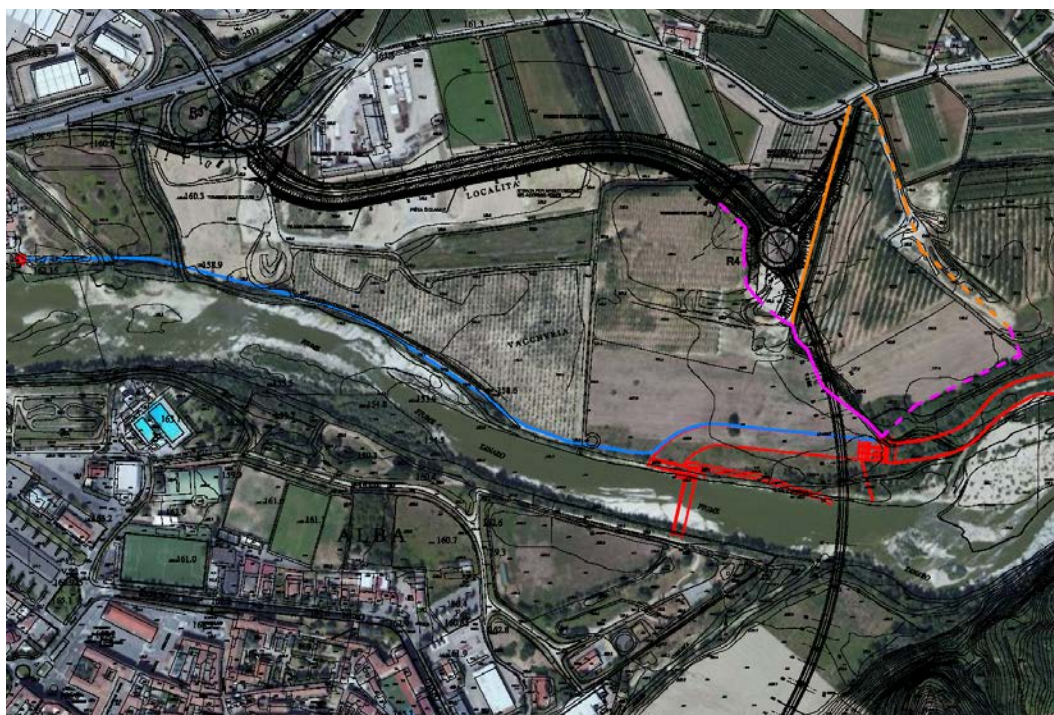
sovrapposizione su foto aerea del terzo ponte in progetto con la planimetria di progetto dell'impianto idroelettrico. Gli elementi costituenti l'impianto idroelettrico sono indicati in rosso, mentre l'elettrodotto interrato è rappresentato in blu. Le piste di accesso esistenti ed in progetto da utilizzare/realizzare in caso di presenza del terzo ponte sono indicate con linee tratteggiate rispettivamente di colore arancione e magenta. Le linee continue in magenta e arancione individuano invece le piste da utilizzare/realizzare in assenza del terzo ponte.
